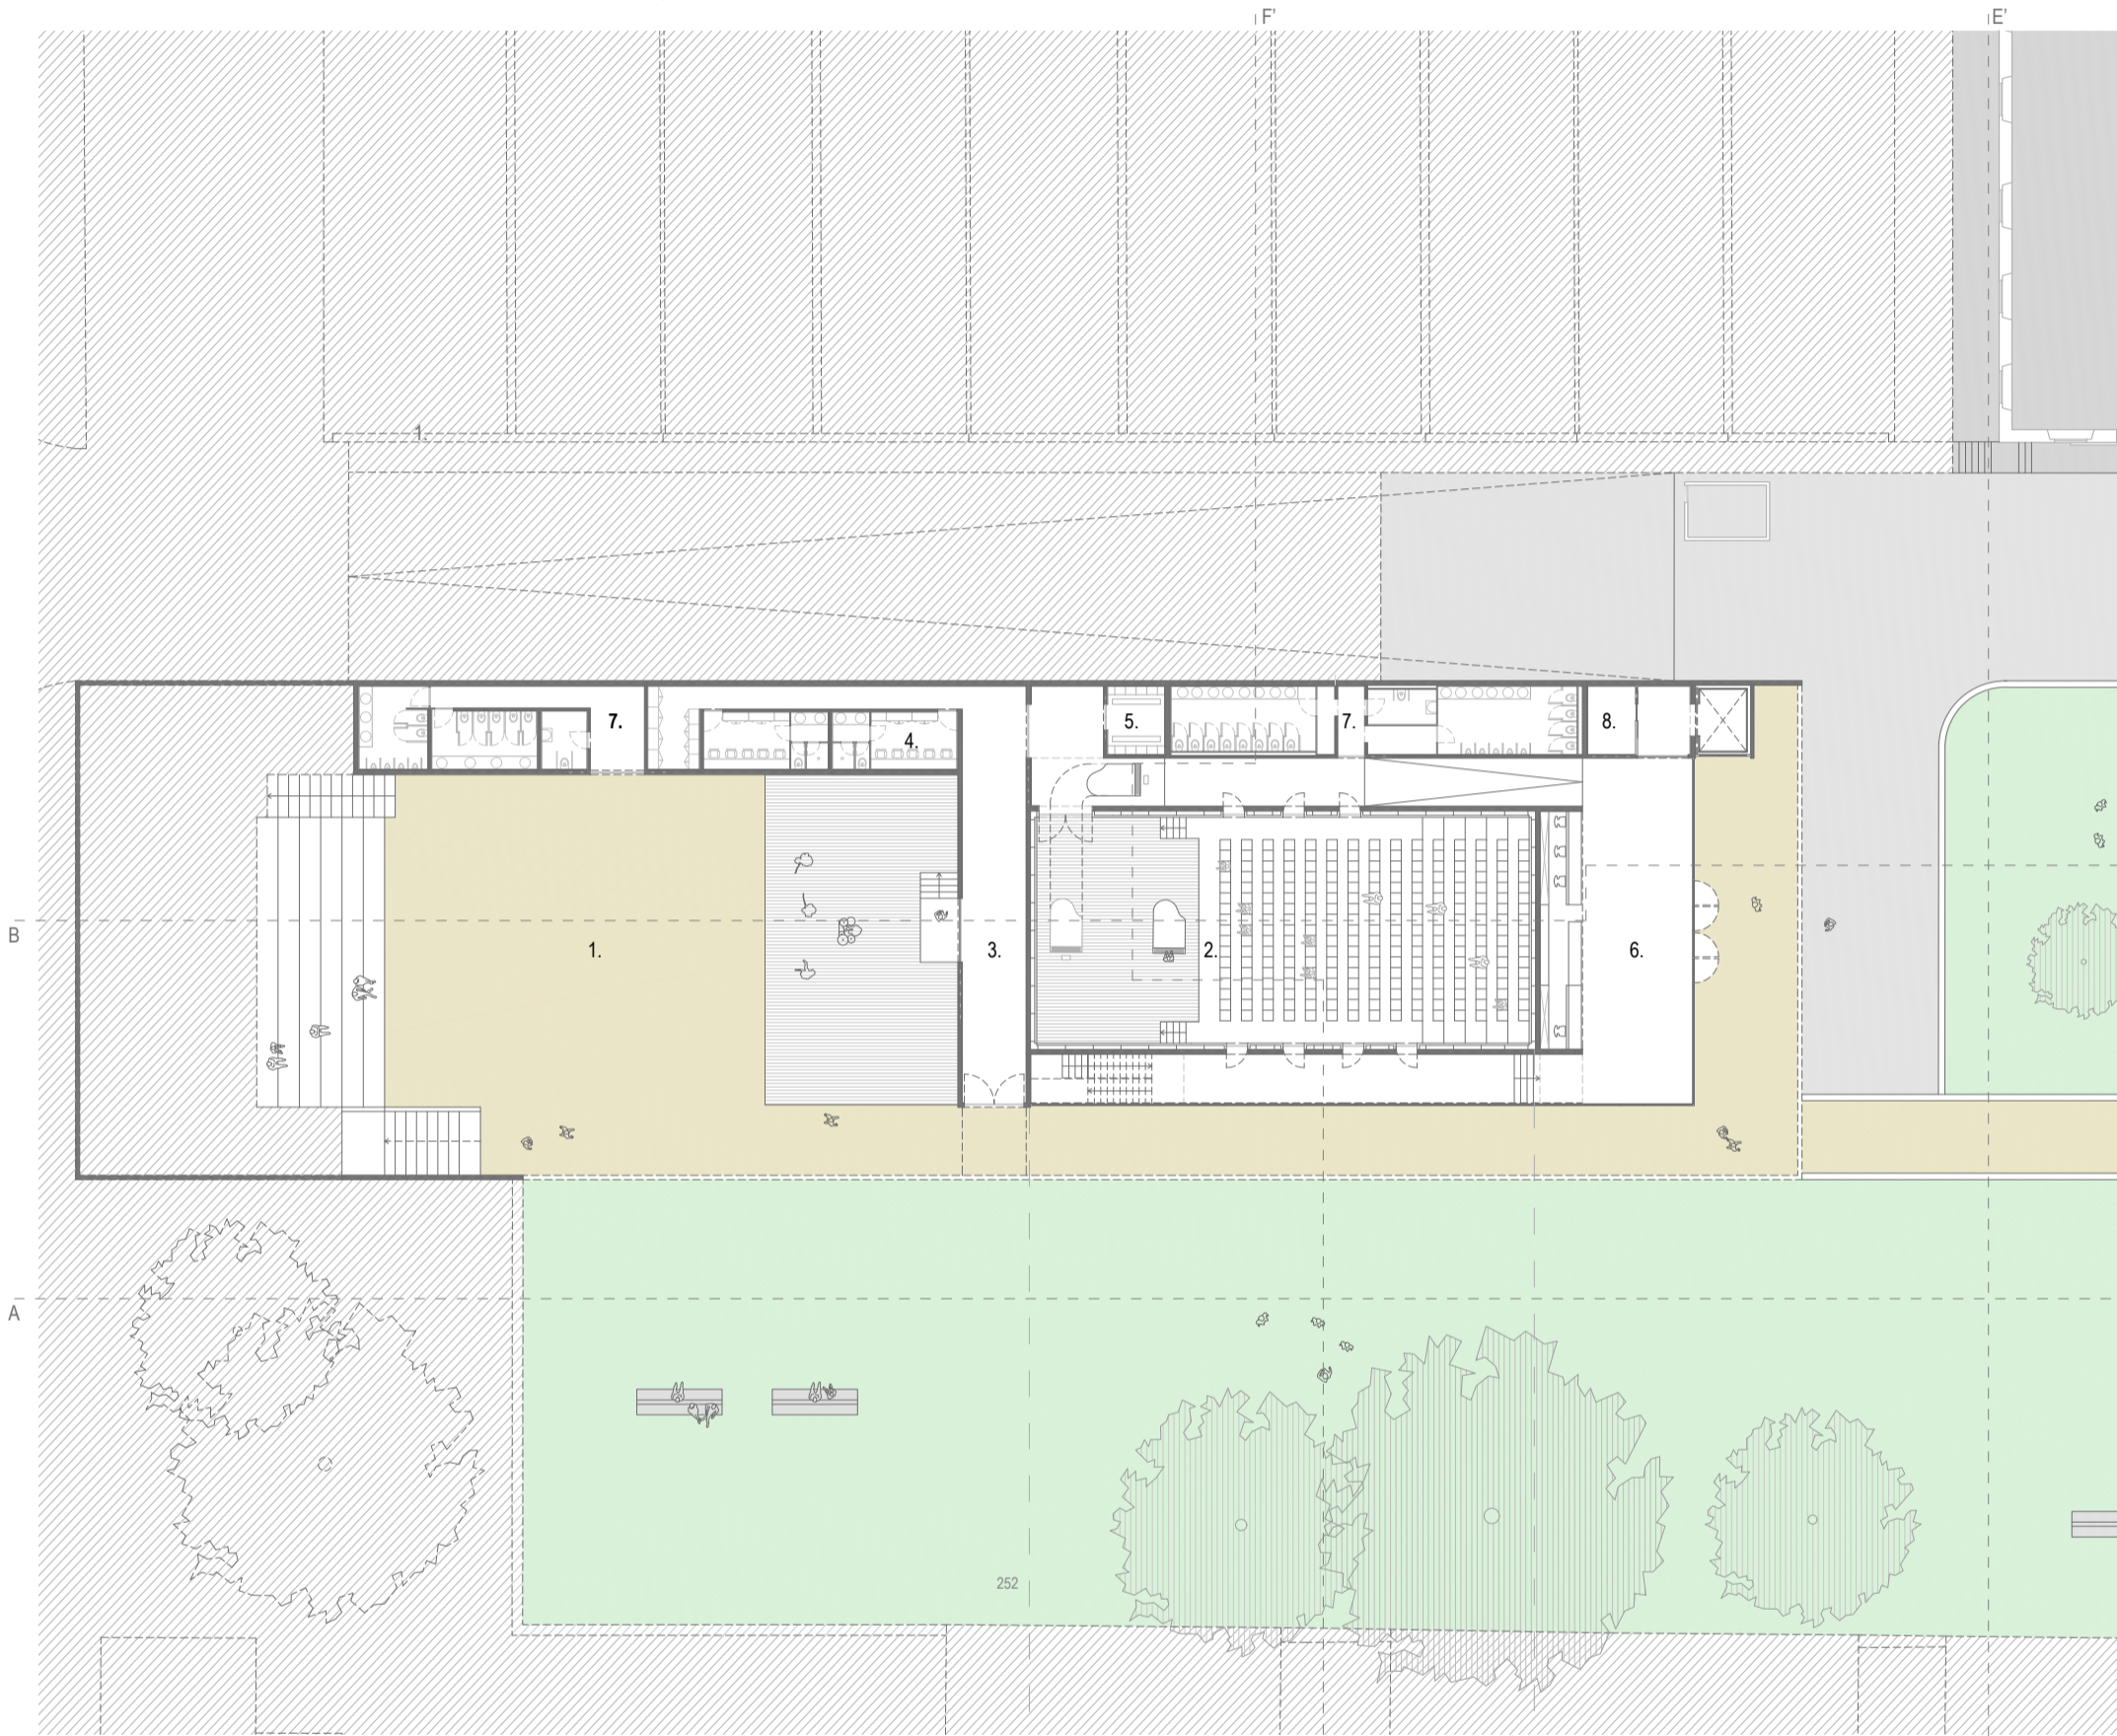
Planta piso 0. Proposta de intervenção, desenho do autor.
